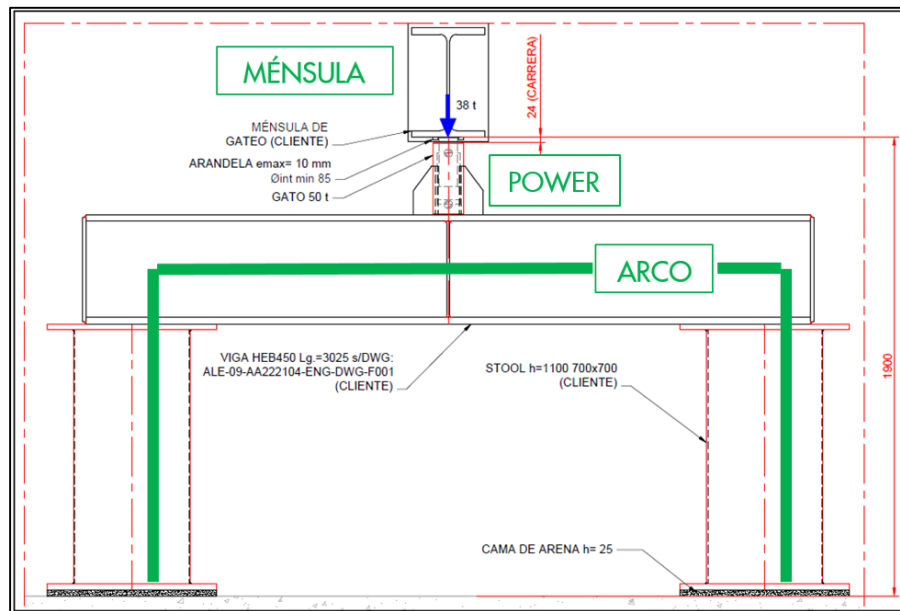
Vista lateral de estructura de soporte de del sistema de elevación
